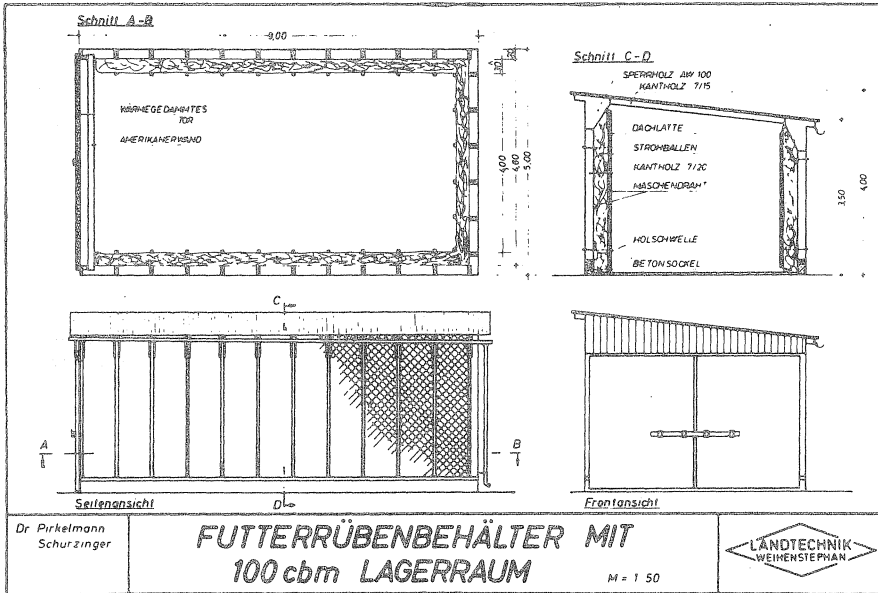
Aufbau eines Futterrübenhochbehälters in Leichtbaukonstruktion.
